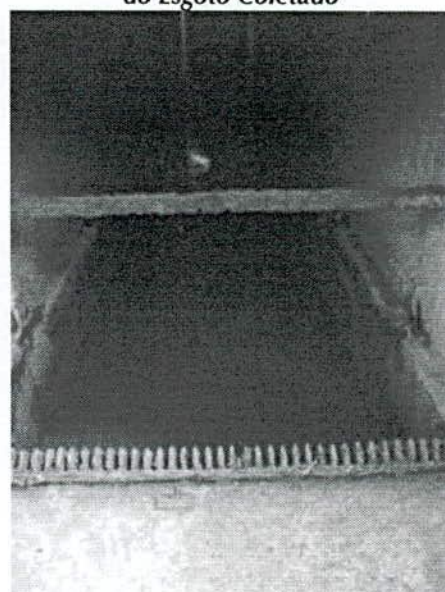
ETE Ipanema – Gradeamento Fino
